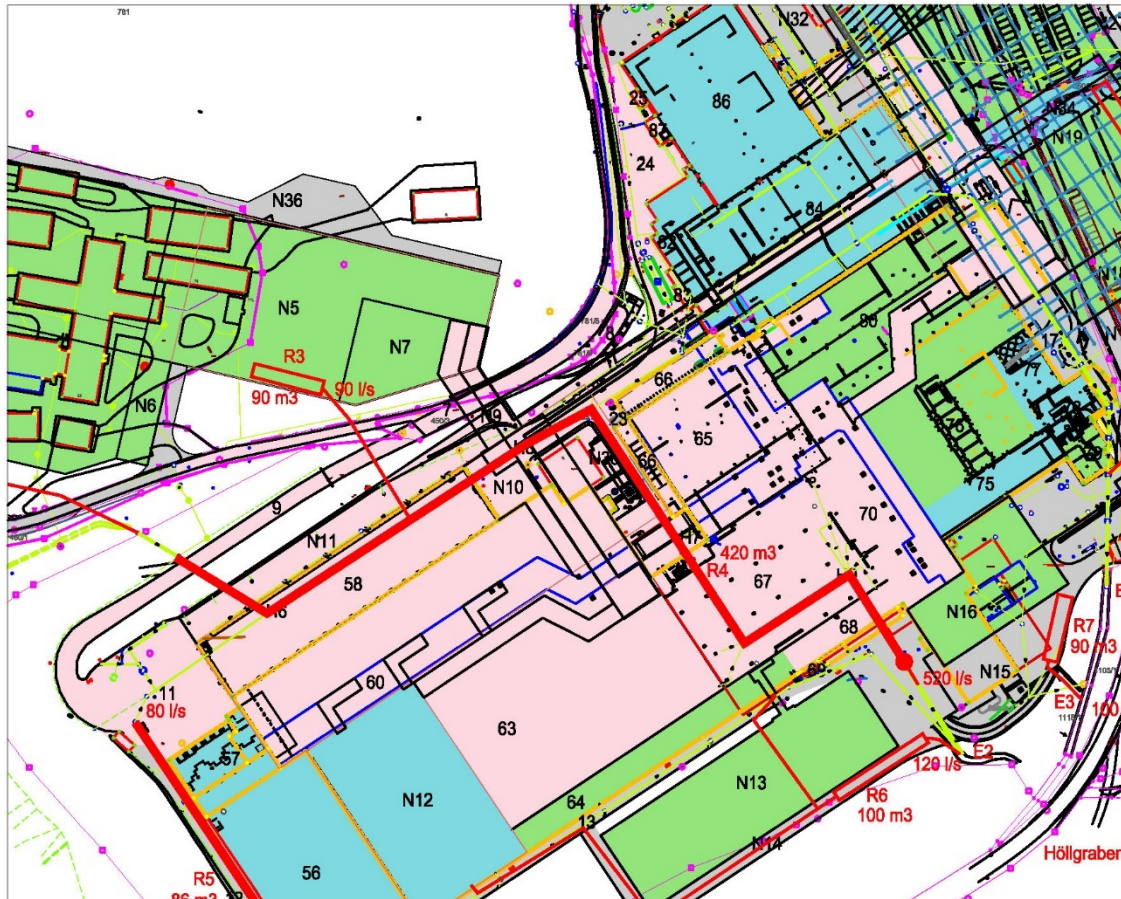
Flächenanteil für R4 – Stauraumkanal Bestand mit Ableitung in Höllgraben
